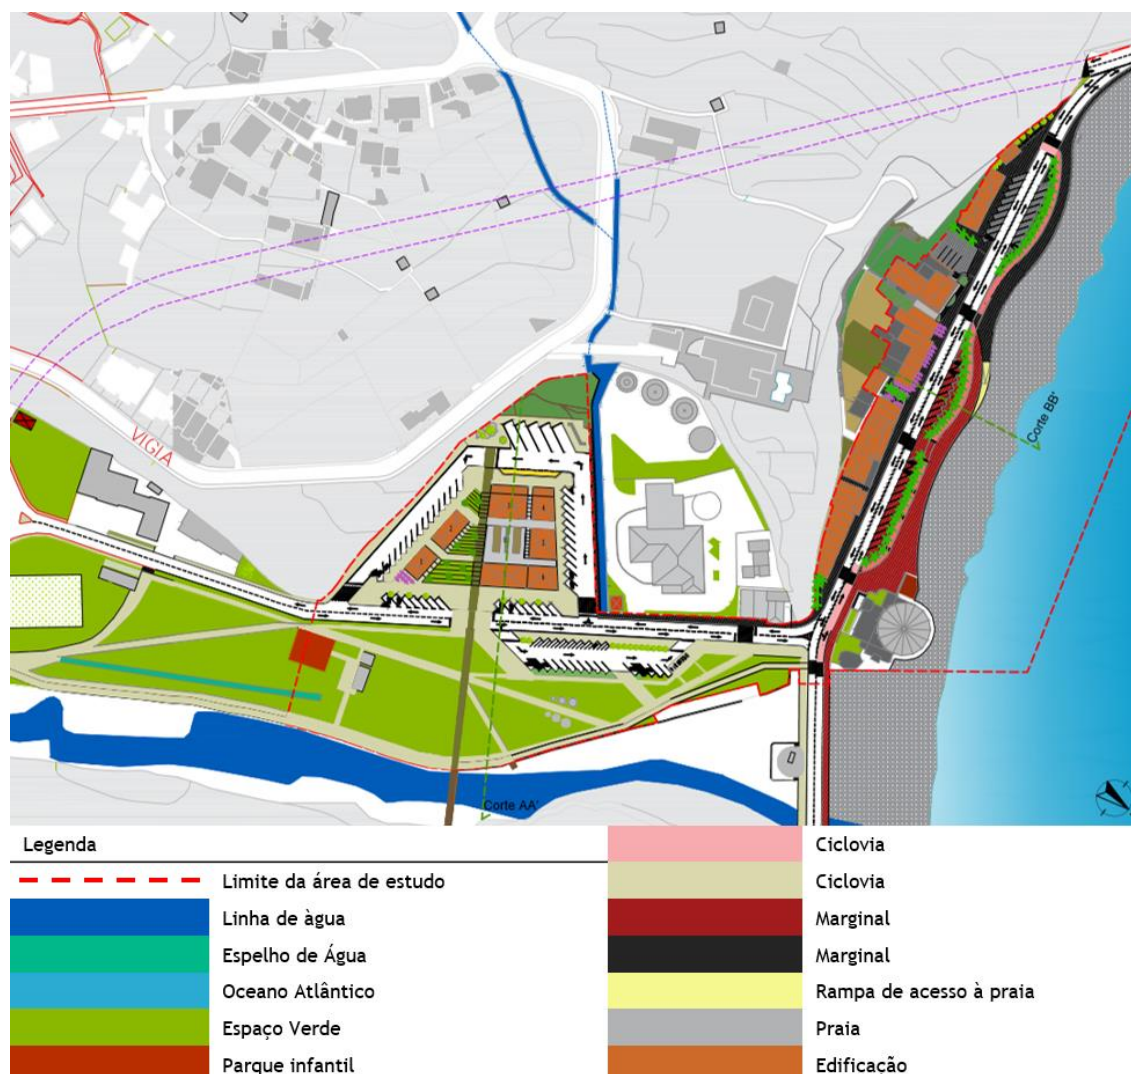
Planta de Proposta: Intervenção Urbana. Global. (Anexo II, Desenho nº13)
